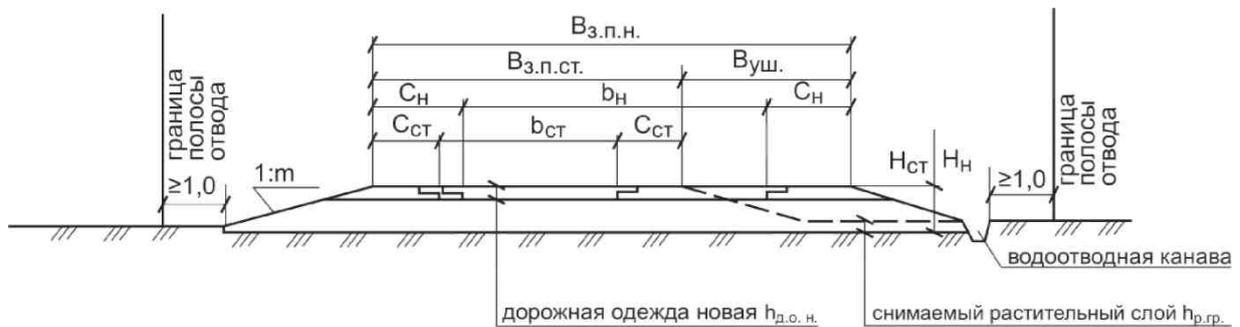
Реконструкция земляного полотна с увеличением ширины насыпи
